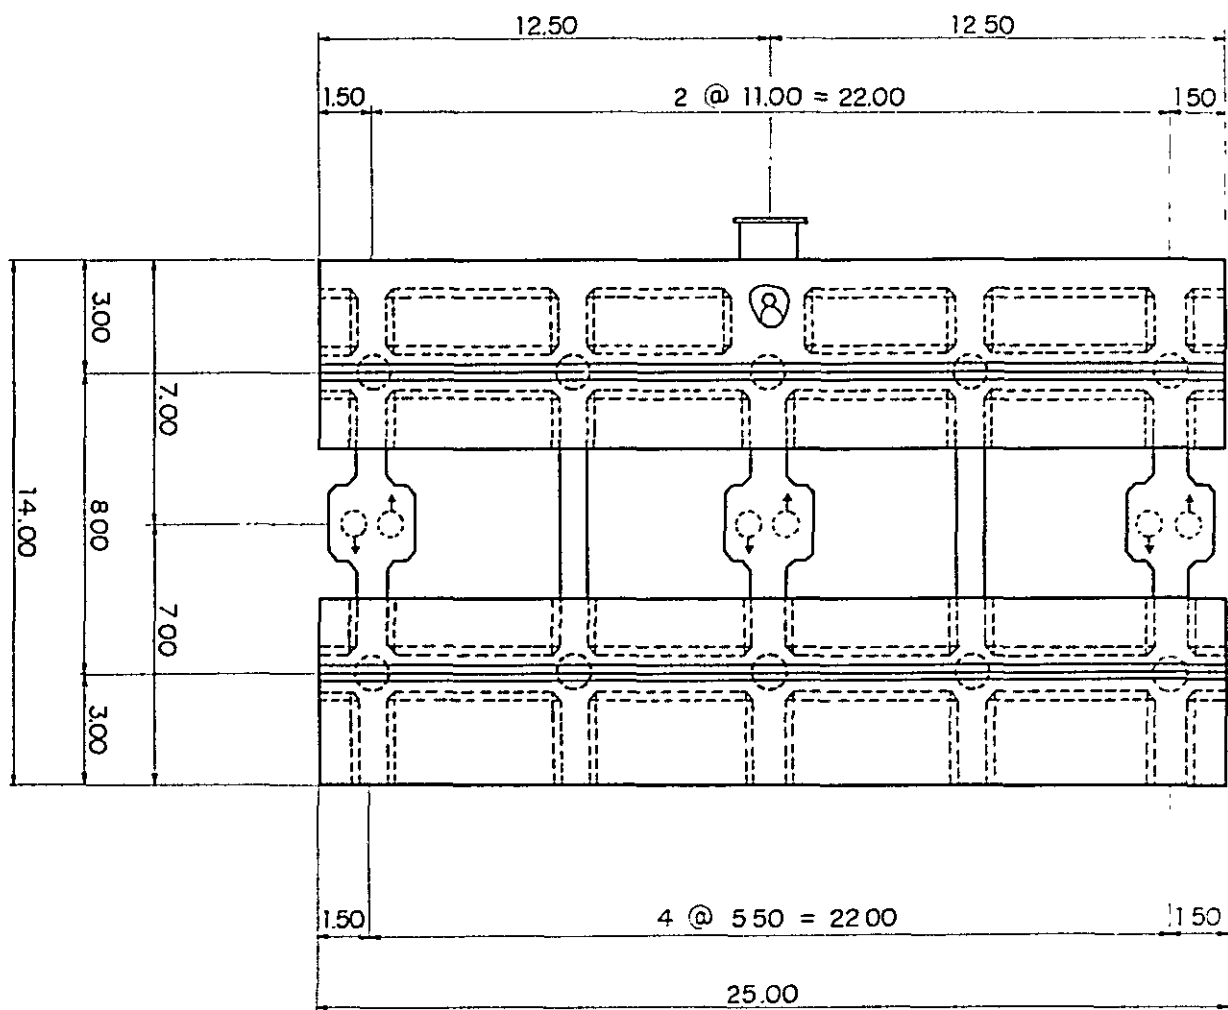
PLANTA DEL MUELLE SEPARADO
